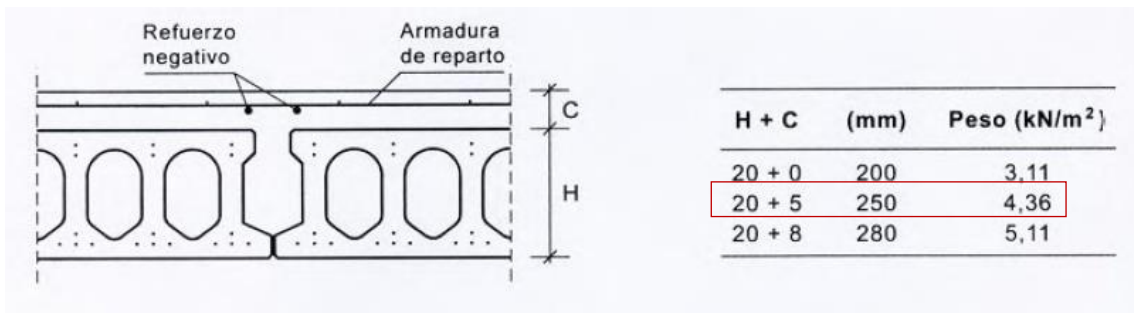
Detalle del espesor del forjado de placas alveolares (20+5 cm). Fuente: Ficha de características técnicas – según EFHE – del forjado de losas alveolares pretensadas (PREFORSA).
